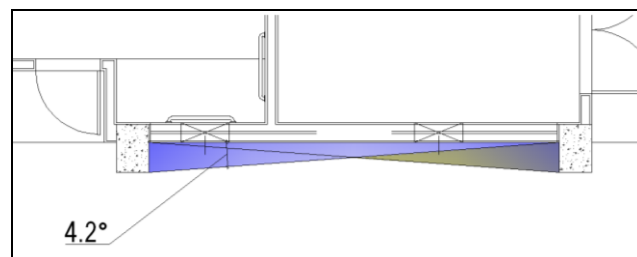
Planta: Ângulo Horizontal de Sombreamento
